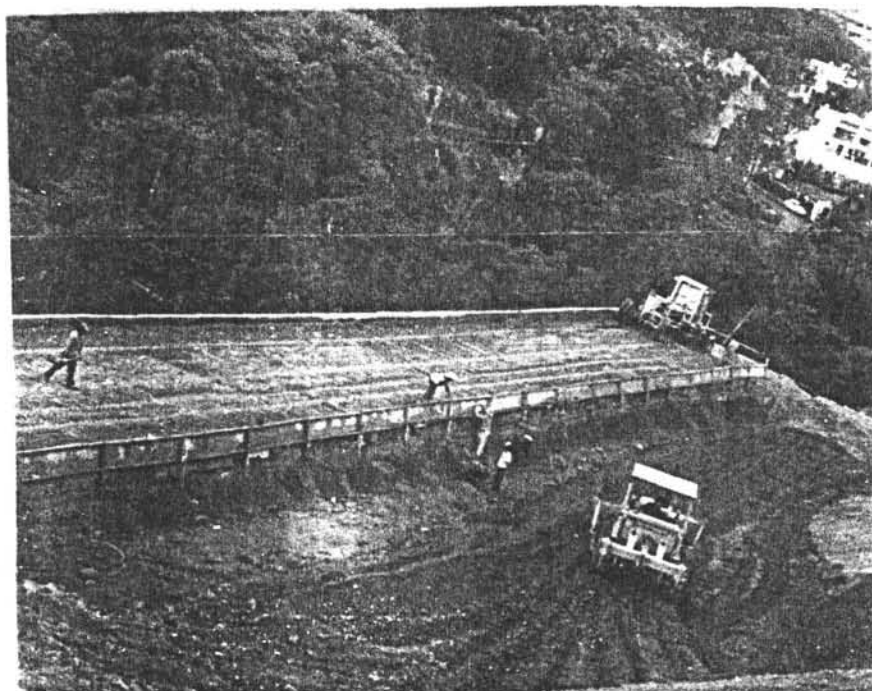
Material de Suelo-Cemento que se mezcla abajo para posteriormente subirlo a la corona del muro de contención.
